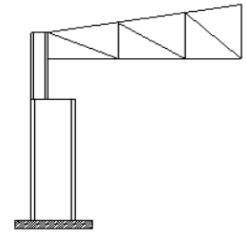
Articulation de poteau avec poutre en treillis ⁹⁰
